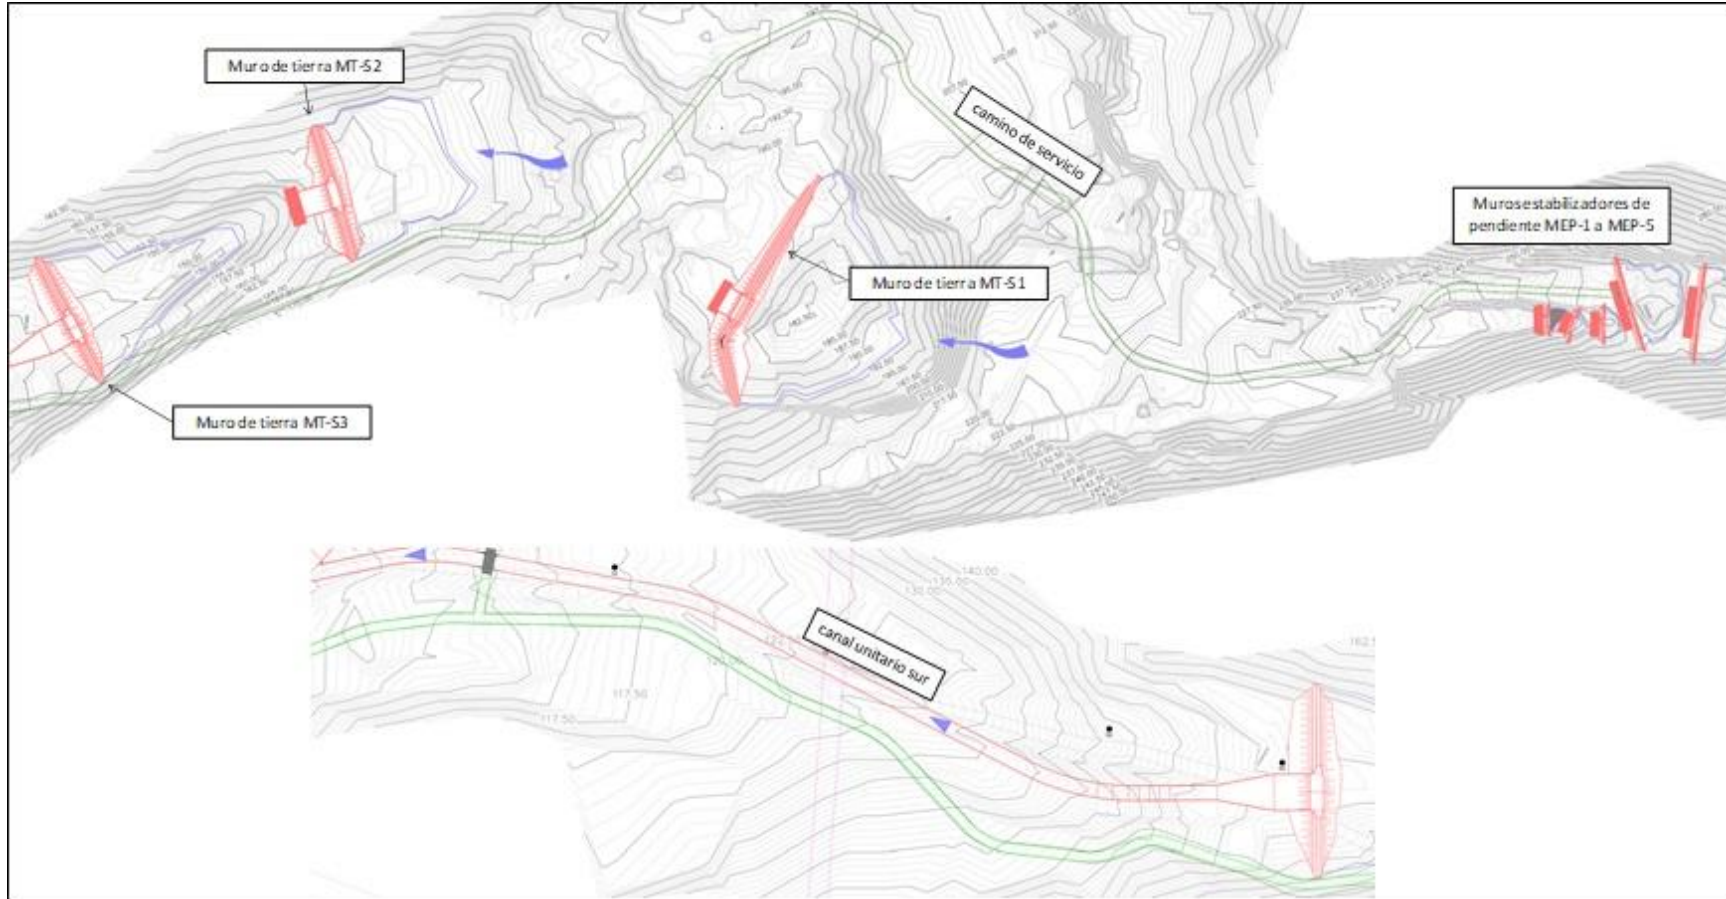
Planta y disposición general de muros estabilizadores de pendiente (MEP)
